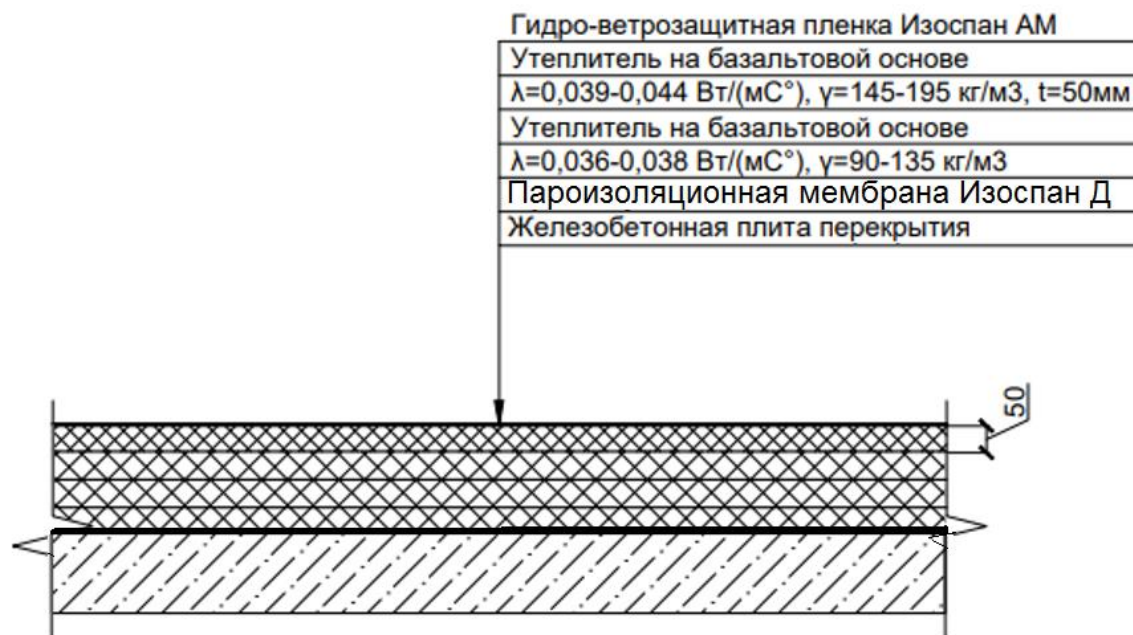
Утепление чердачного перекрытия железобетонного (плоские плиты)
